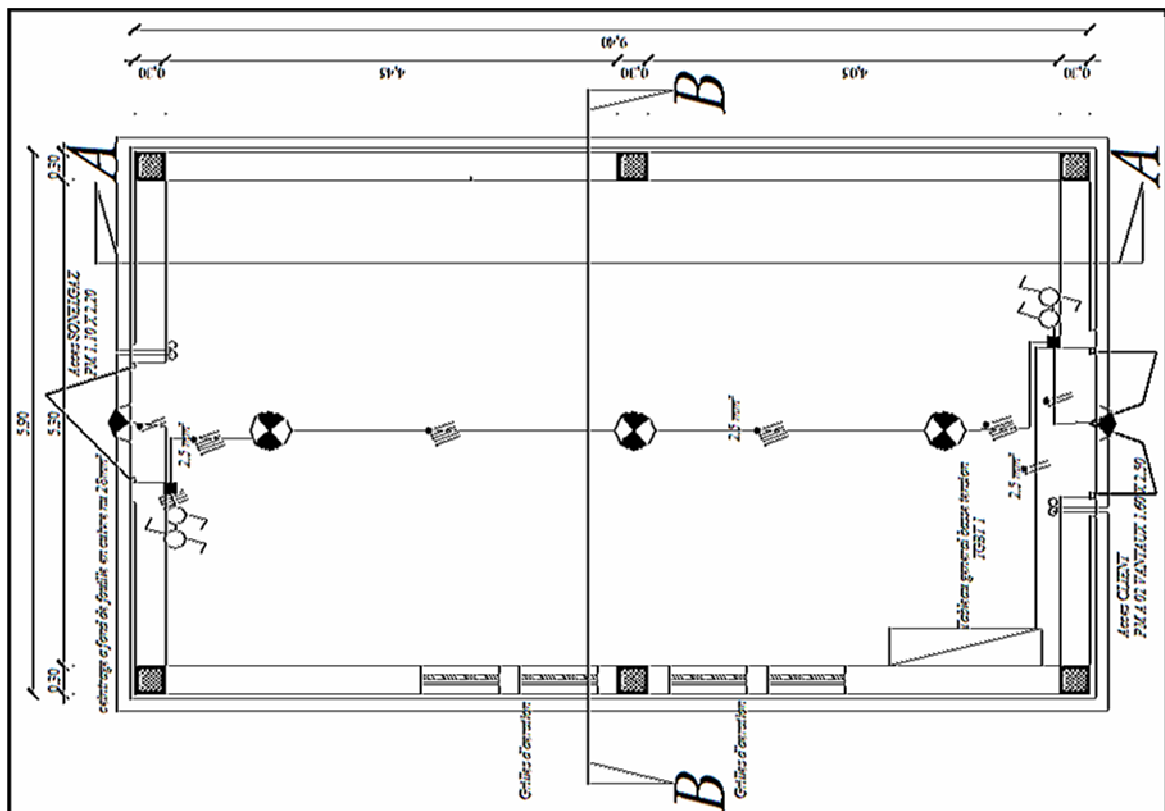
Plan d'éclairage de prise de terre d'un poste livraison à comptage MT
